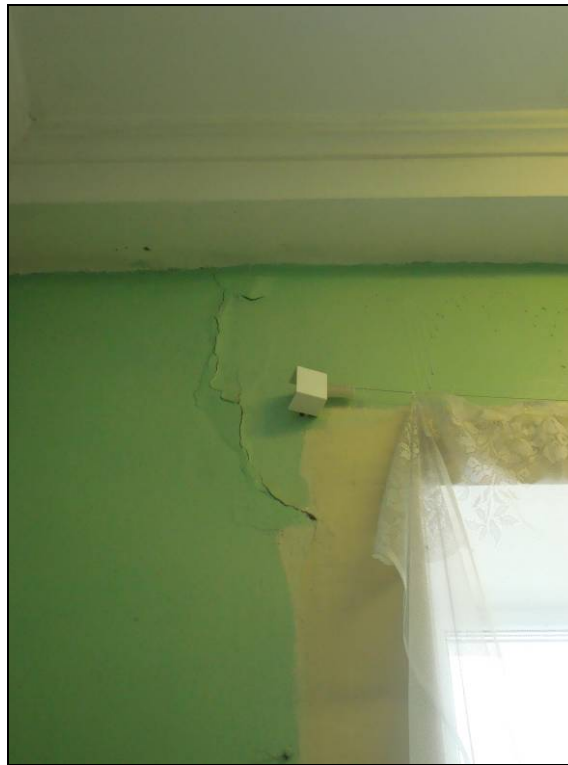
Трещина по керамзитобетонному блоку в стене лестничной клетки (оси Ж/2-3) образовавшаяся из-за разности осадок фундаментов.
